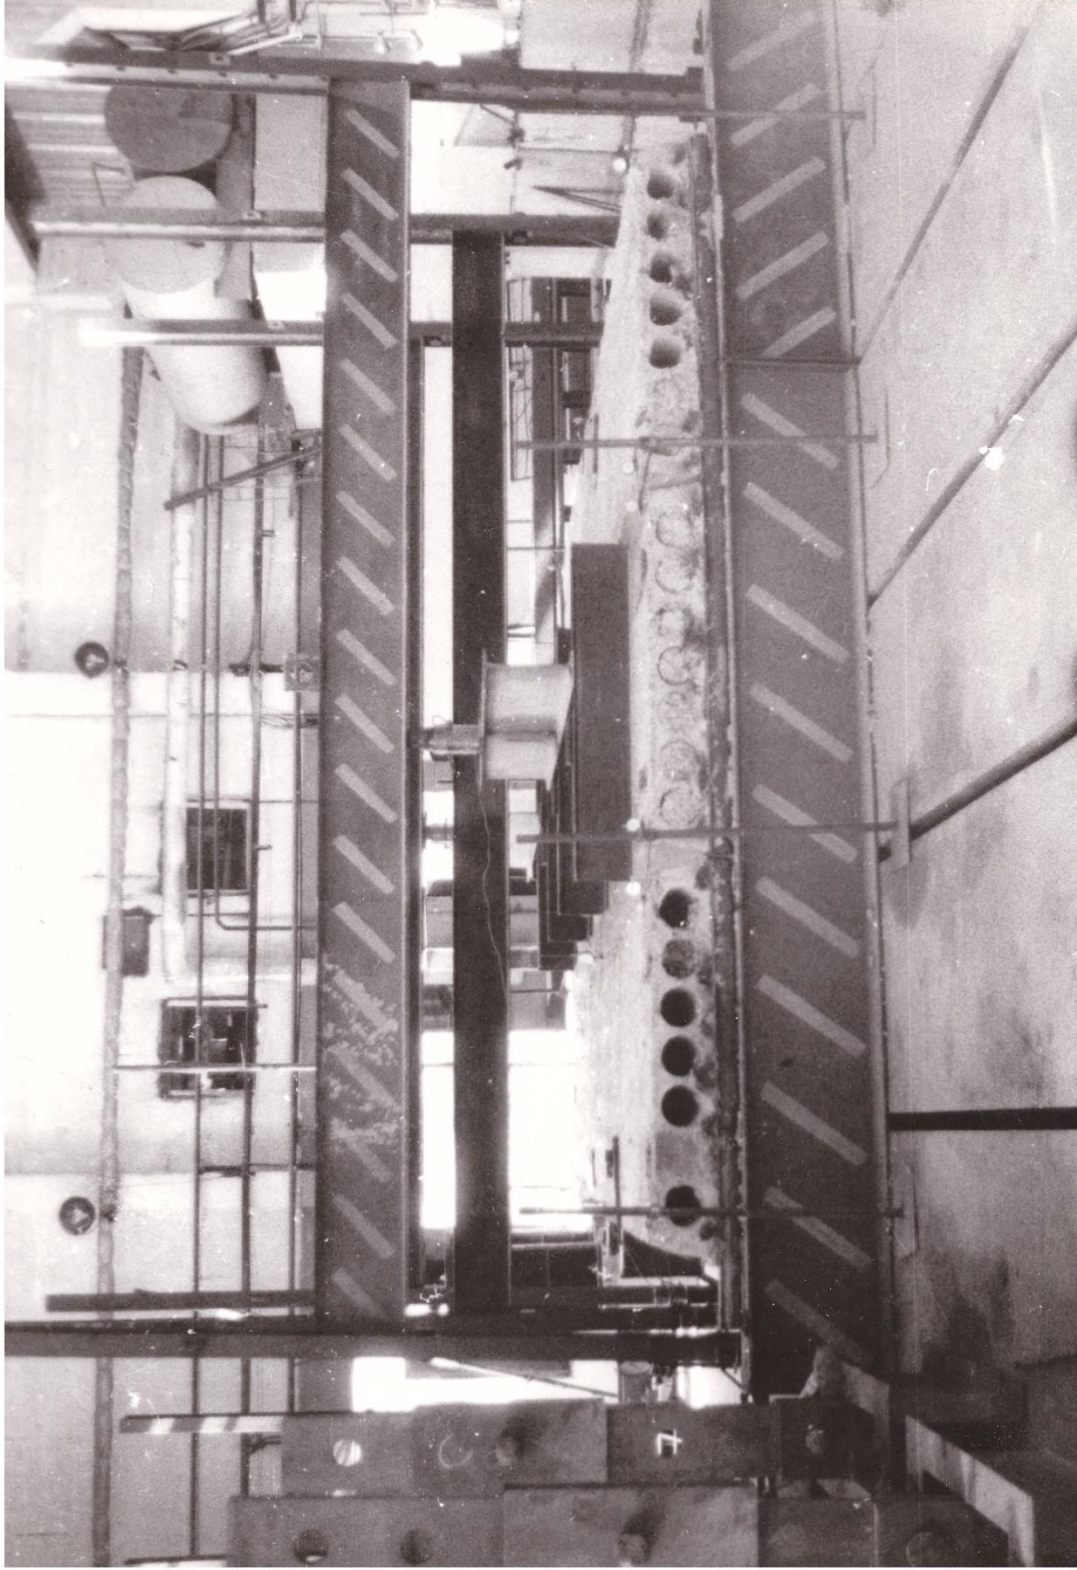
Общий вид испытаний фрагмента перекрытия из многопустотных плит
